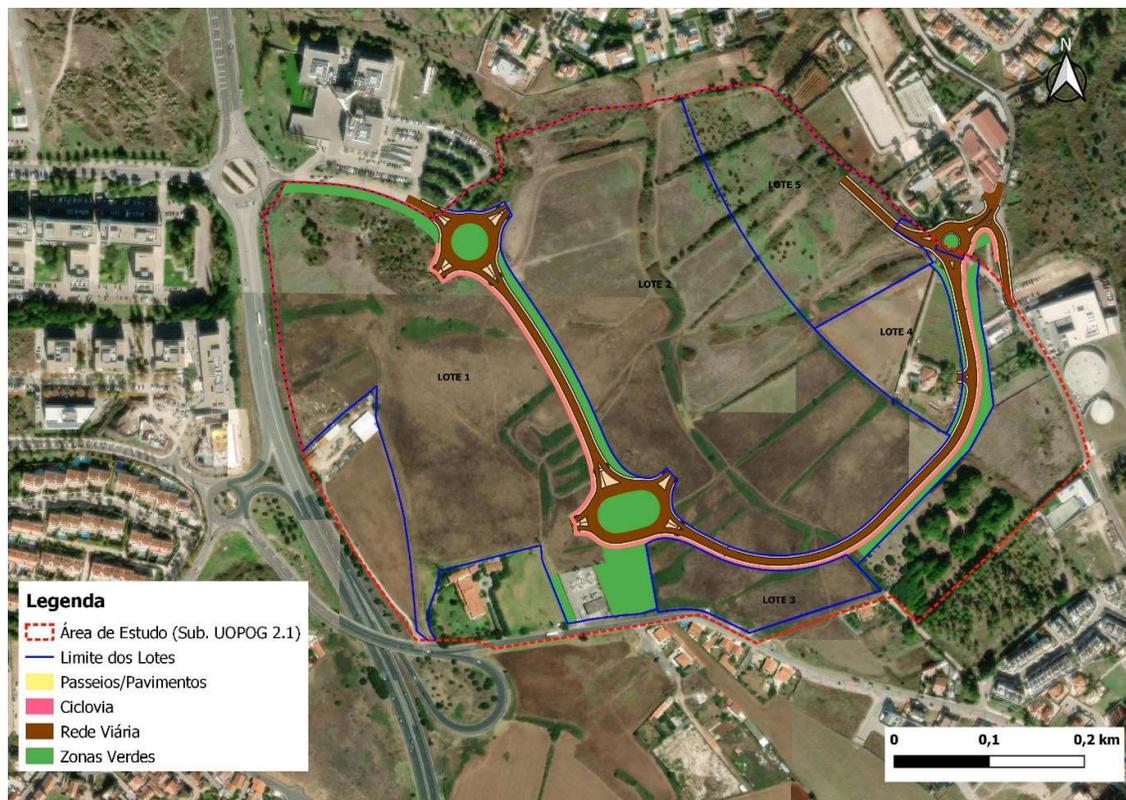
Planta síntese da operação de loteamento da Sub.UOPOG 2.1 do Taguspark – Fase de Loteamento
